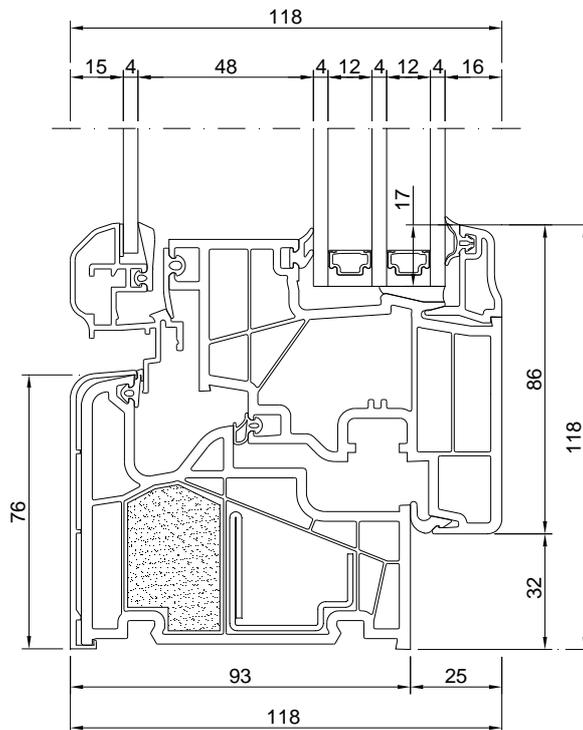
Querschnittdarstellung Rahmenprofil mit 3-fach Isolierverglasung im Verbund und Abstandhalter Technoform „TGI-Spacer“
